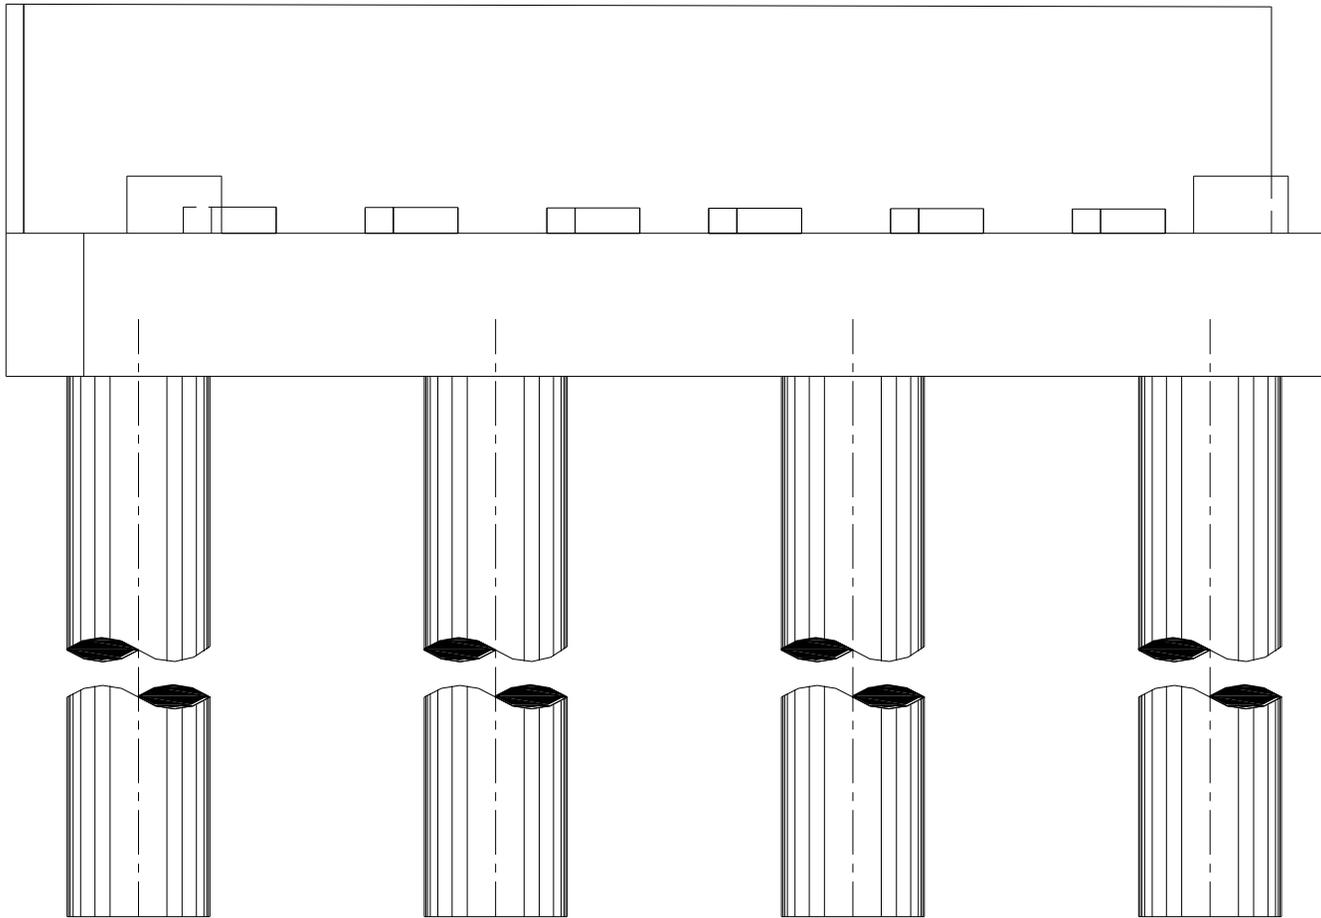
Elemento caballete del proyecto "Las Lajas III"
